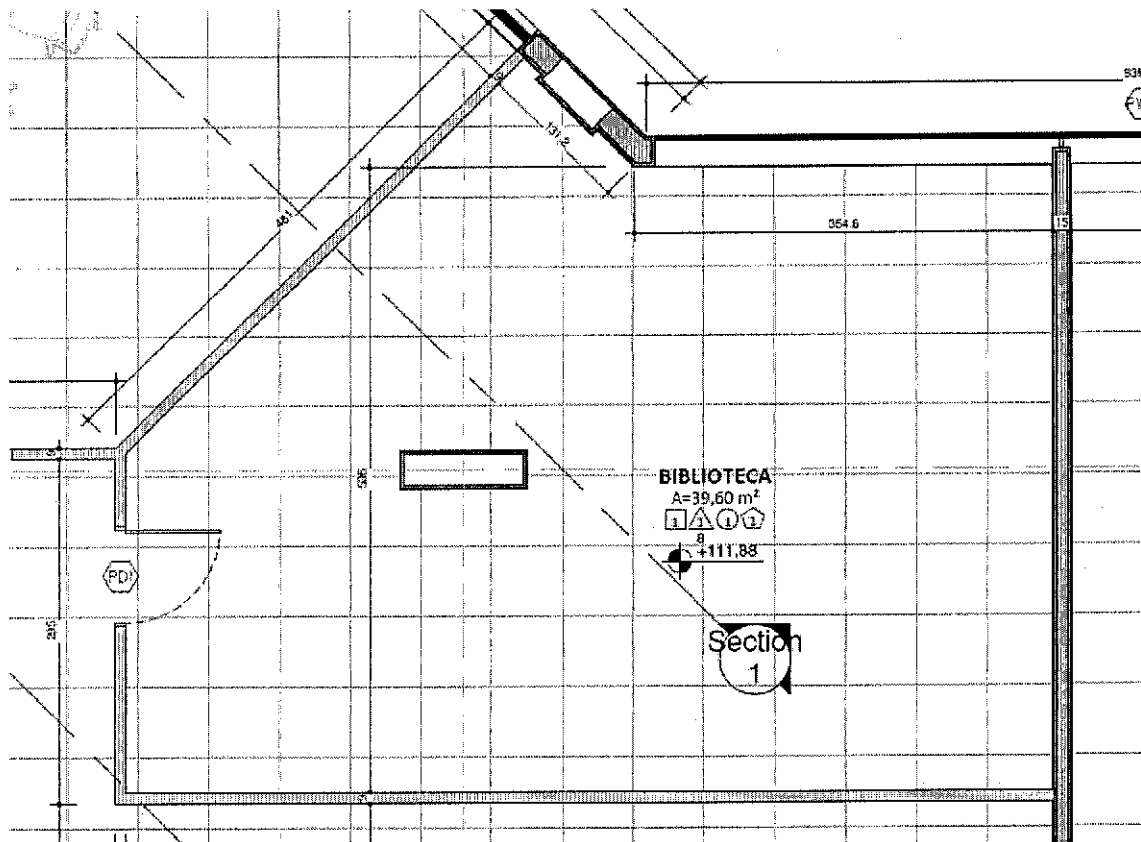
planta do 2º pavimento da obra DRF Bauru (CAT 2620180009585), área de biblioteca com 39,60m². Obra de Construção.
